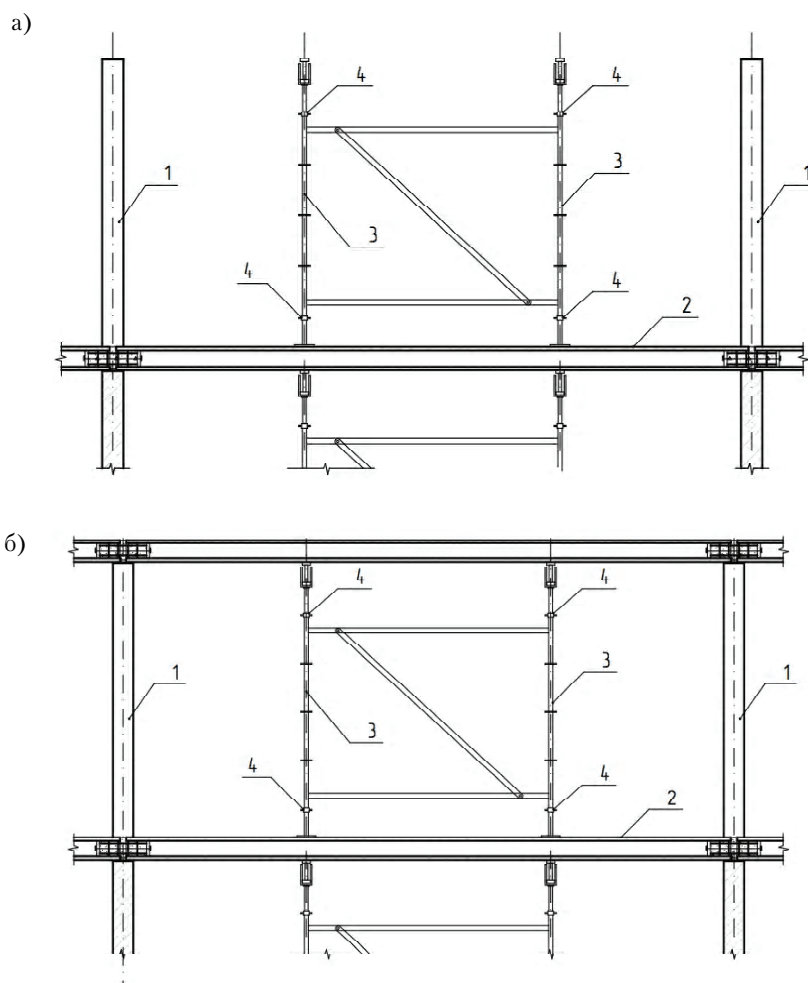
Установка сборных железобетонных плит перекрытия: а) предварительная установка временных пространственных опор; б) установка плит перекрытия на опоры: 1 – вертикальные несущие конструкции; 2 – сборные железобетонные плиты перекрытия; 3 – временная пространственная опора; 4 – винтовые домкраты.
